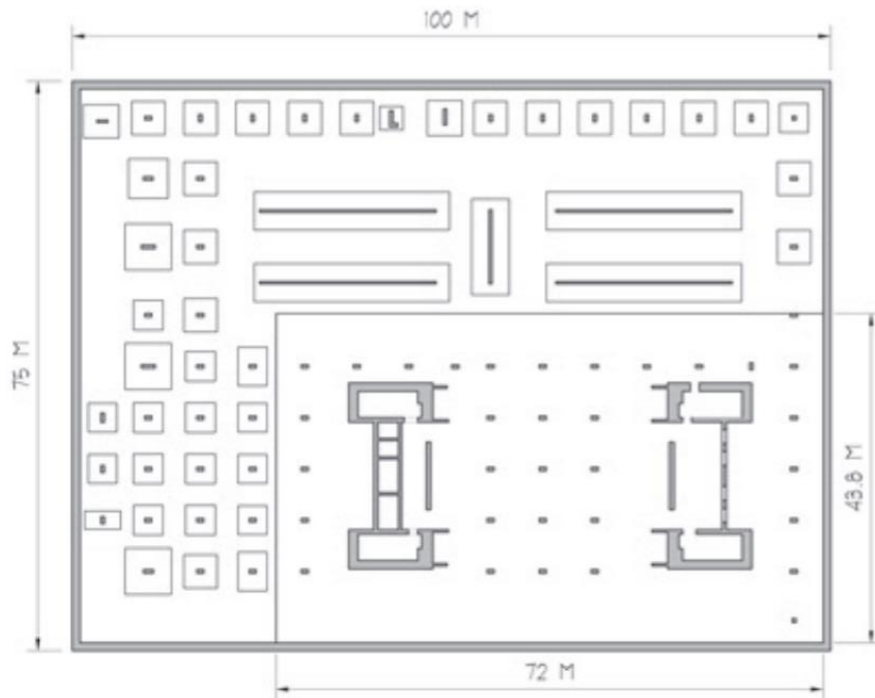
Planta cimentación Torre Caja Madrid, extraída de internet
